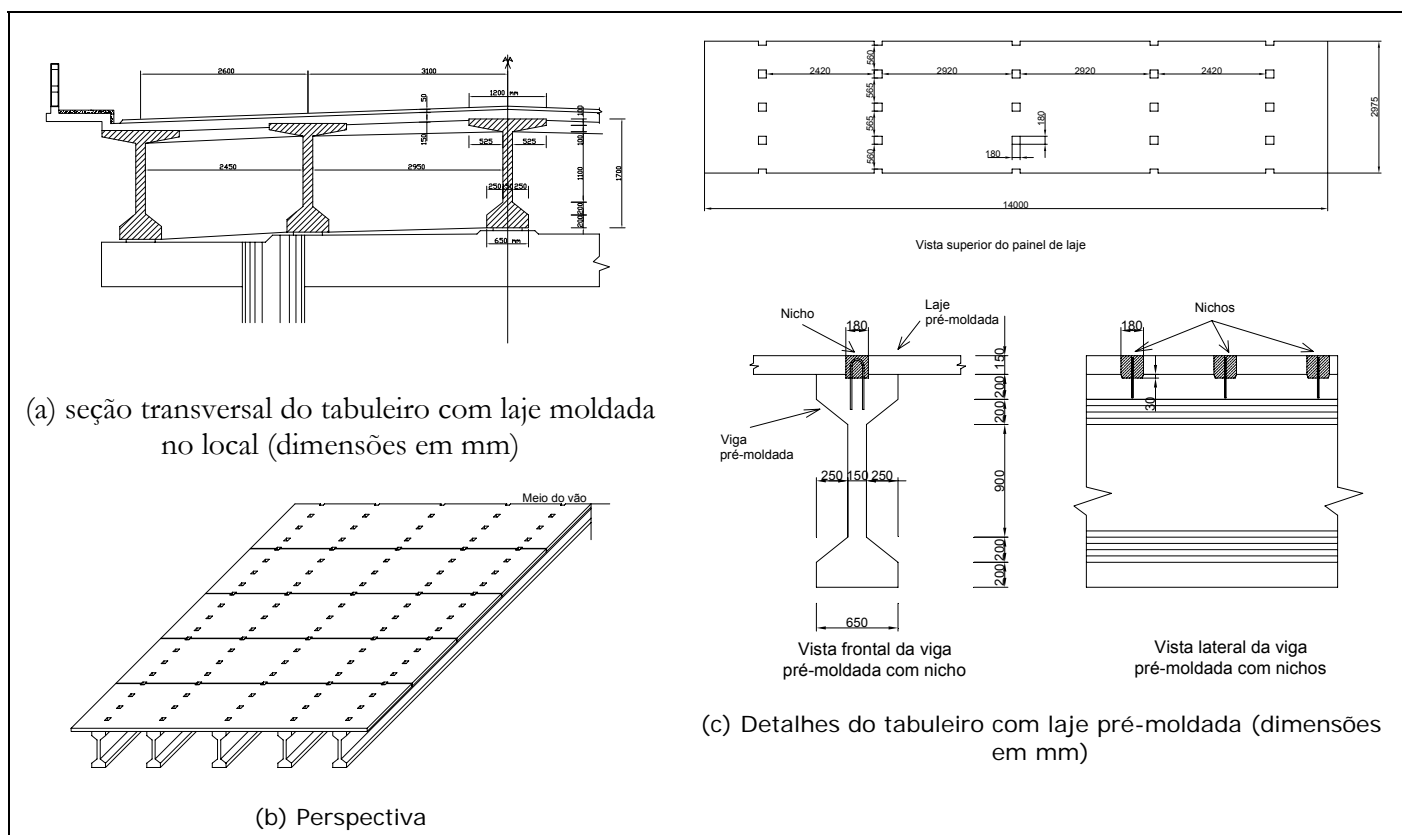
Tabuleiro de ponte com viga e laje pré-moldadas.
